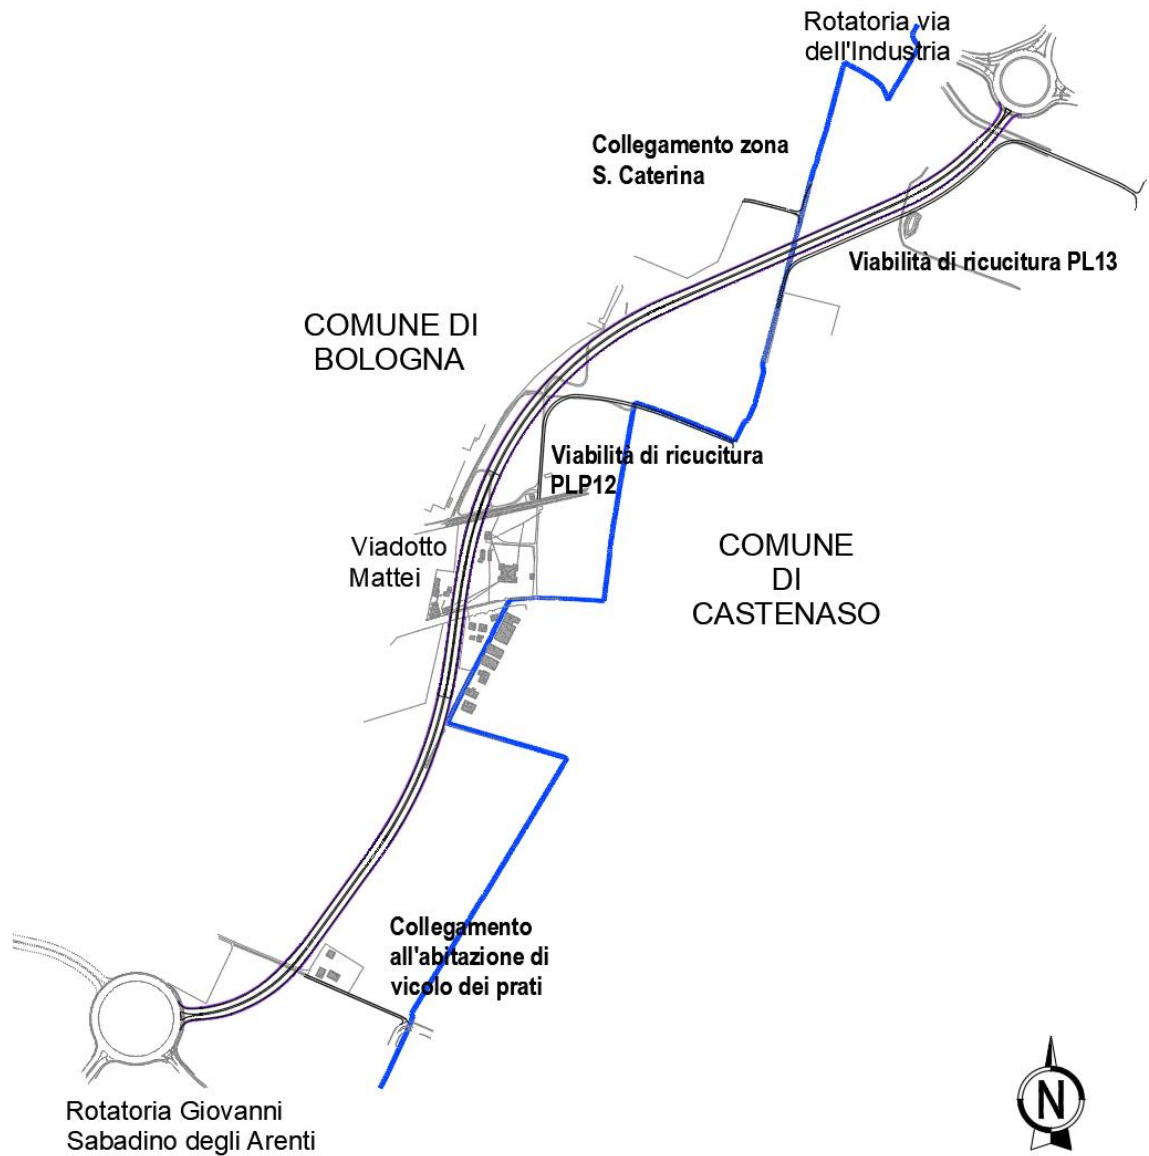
Planimetria schematica della strada Lungo Savena III lotto e degli interventi connessi
